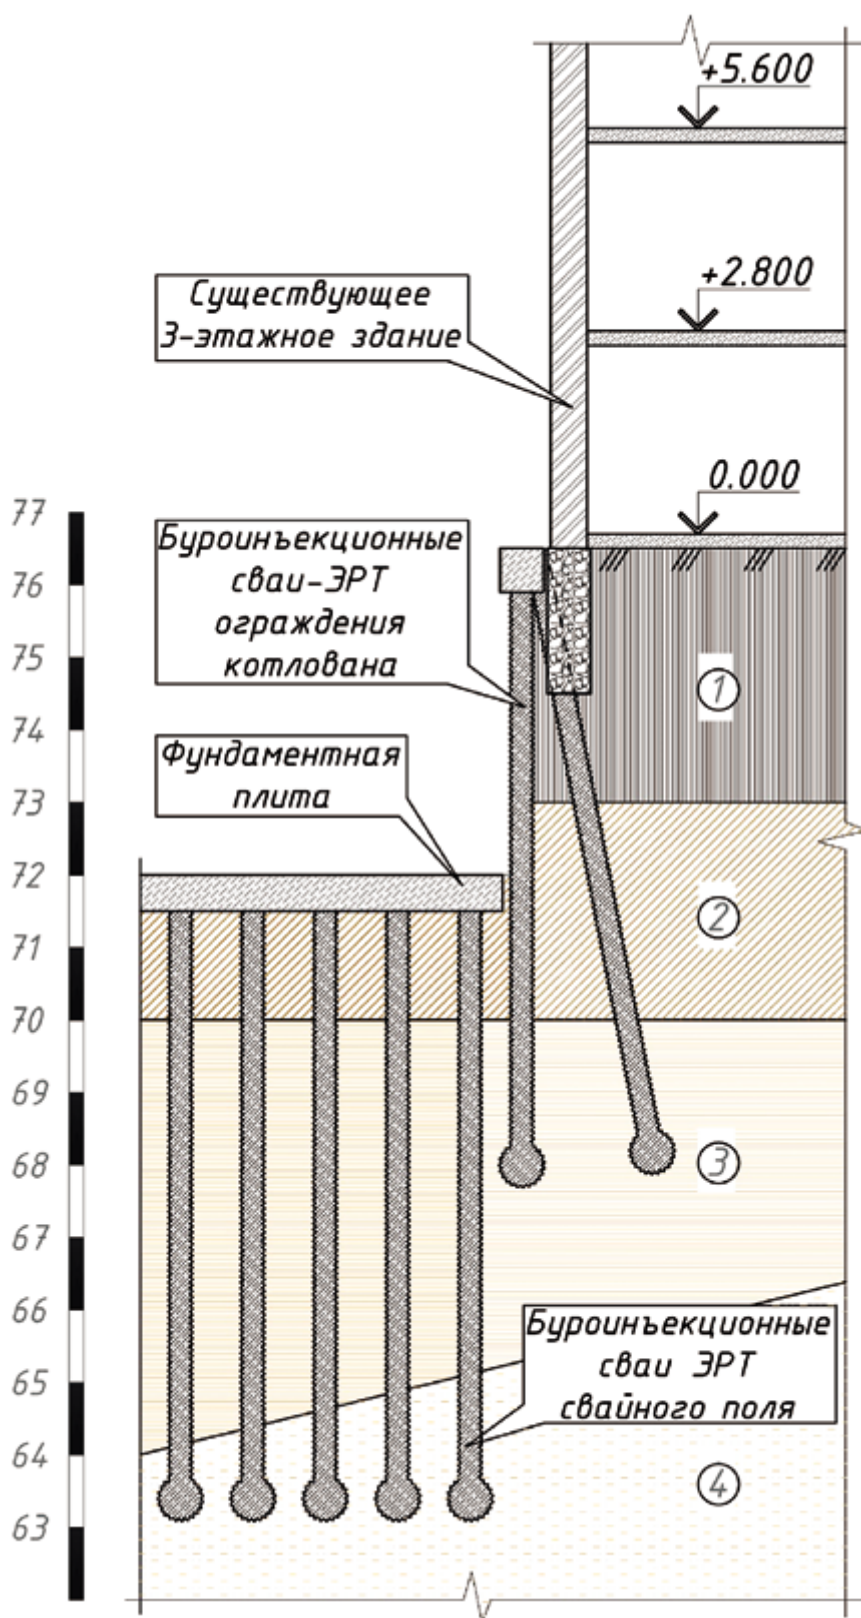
Схема усиления основания фундаментов существующего трехэтажного здания с помощью буринъекционных свай ЭРТ: 1 – насыпной грунт; 2 – песок пылеватый; 3 – песок мелкий; 4 – песок средней крупности
